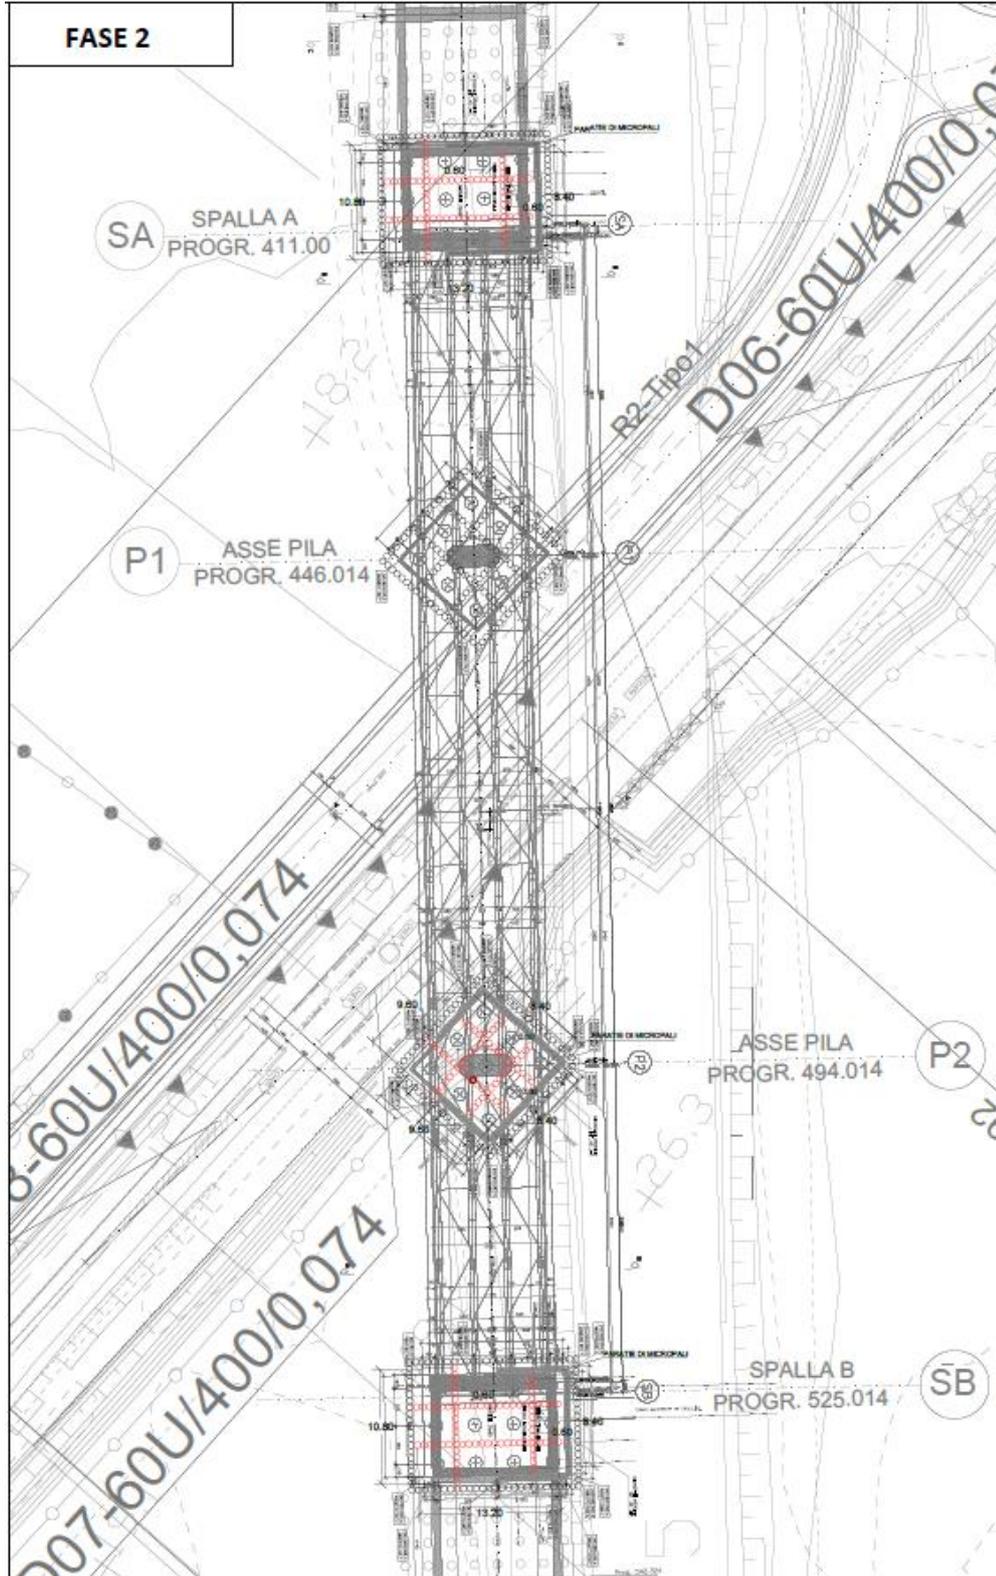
Sezione rappresentativa tratta IV01 - fondazioni su pali – Fase 2
